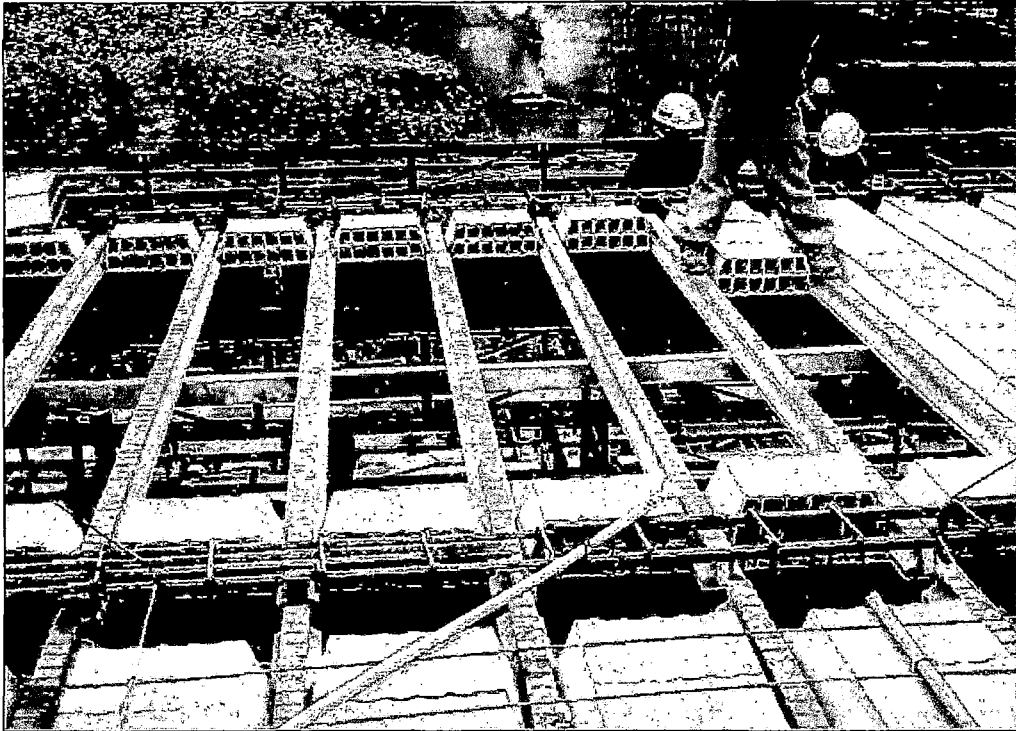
Colocación de viguetas pretensadas y bovedillas
